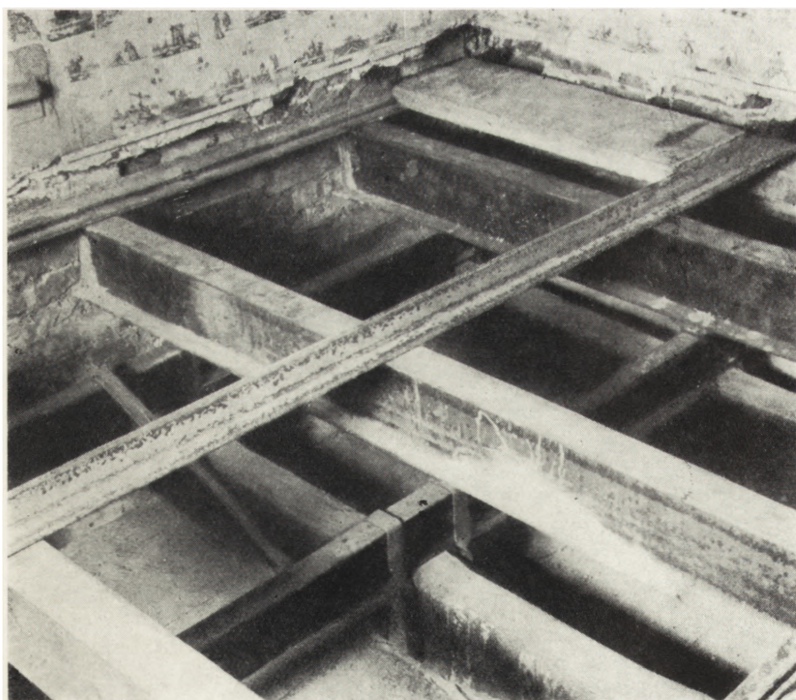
Skrzydło południowe, podwieszanie plafonu do wiązarów stalowej konstrukcji dachowej (fot. Pracownia Konserwacji Zabytków)
